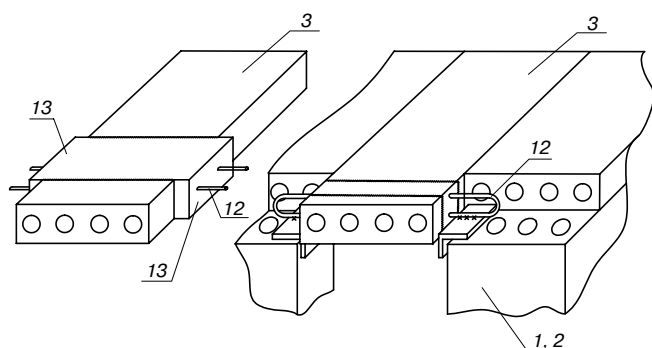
Вариант опирания плиты перекрытия в зоне стенового проема с опиранием через закладные металлические элементы
